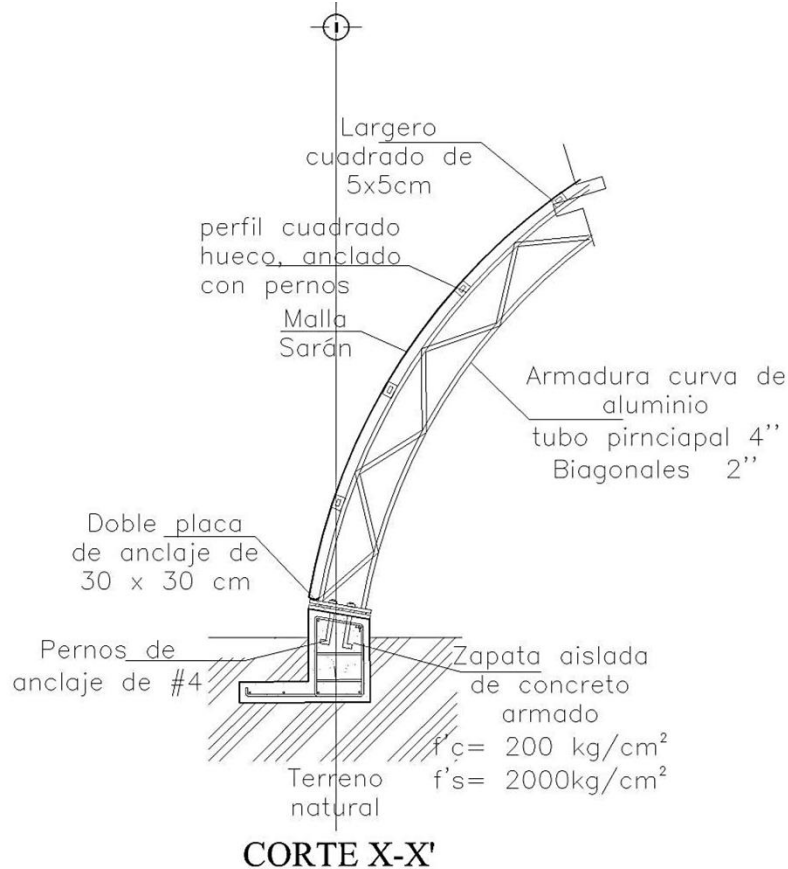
Corte por fachada Mariposario, extracto plano ES-5.
